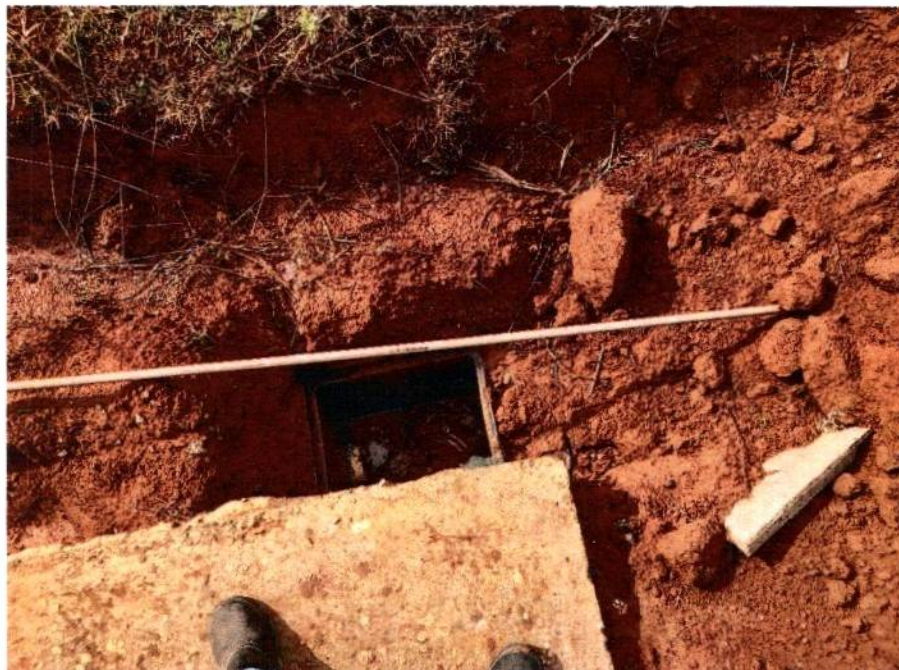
CAIXA DE ESGOTO SANITÁRIO
